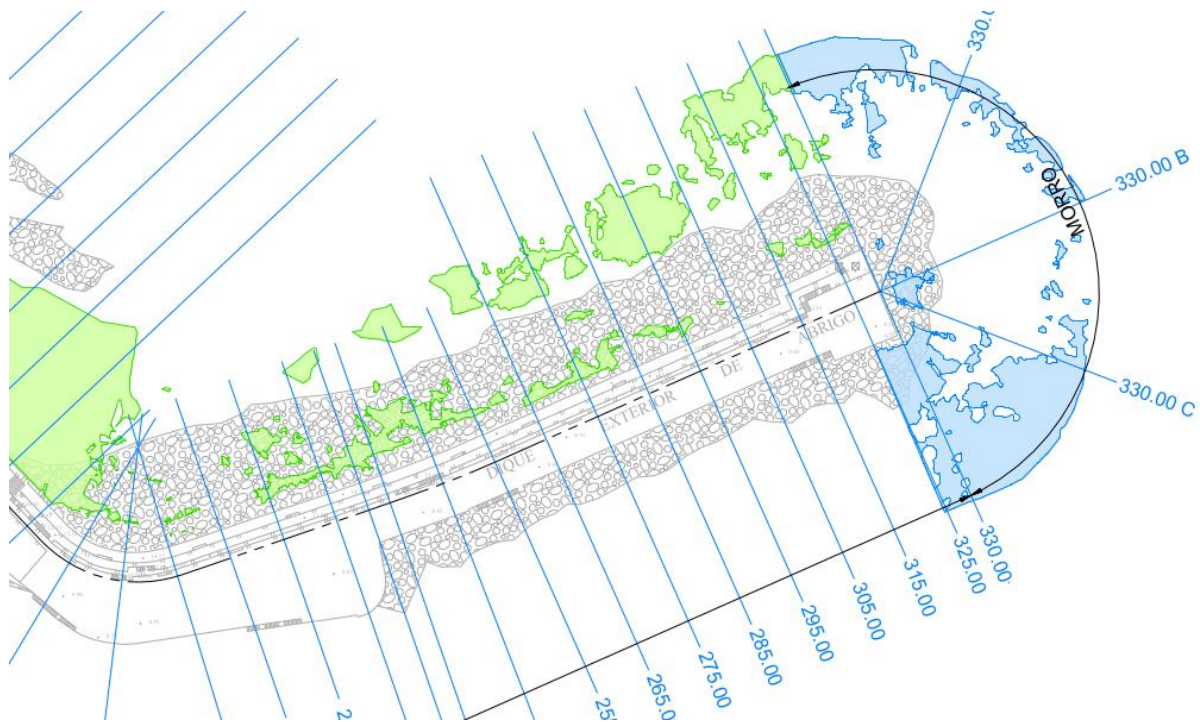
Planta de distribución de bloques en Tramo 2 y Morro. Fuente: TYPESA (2021)
